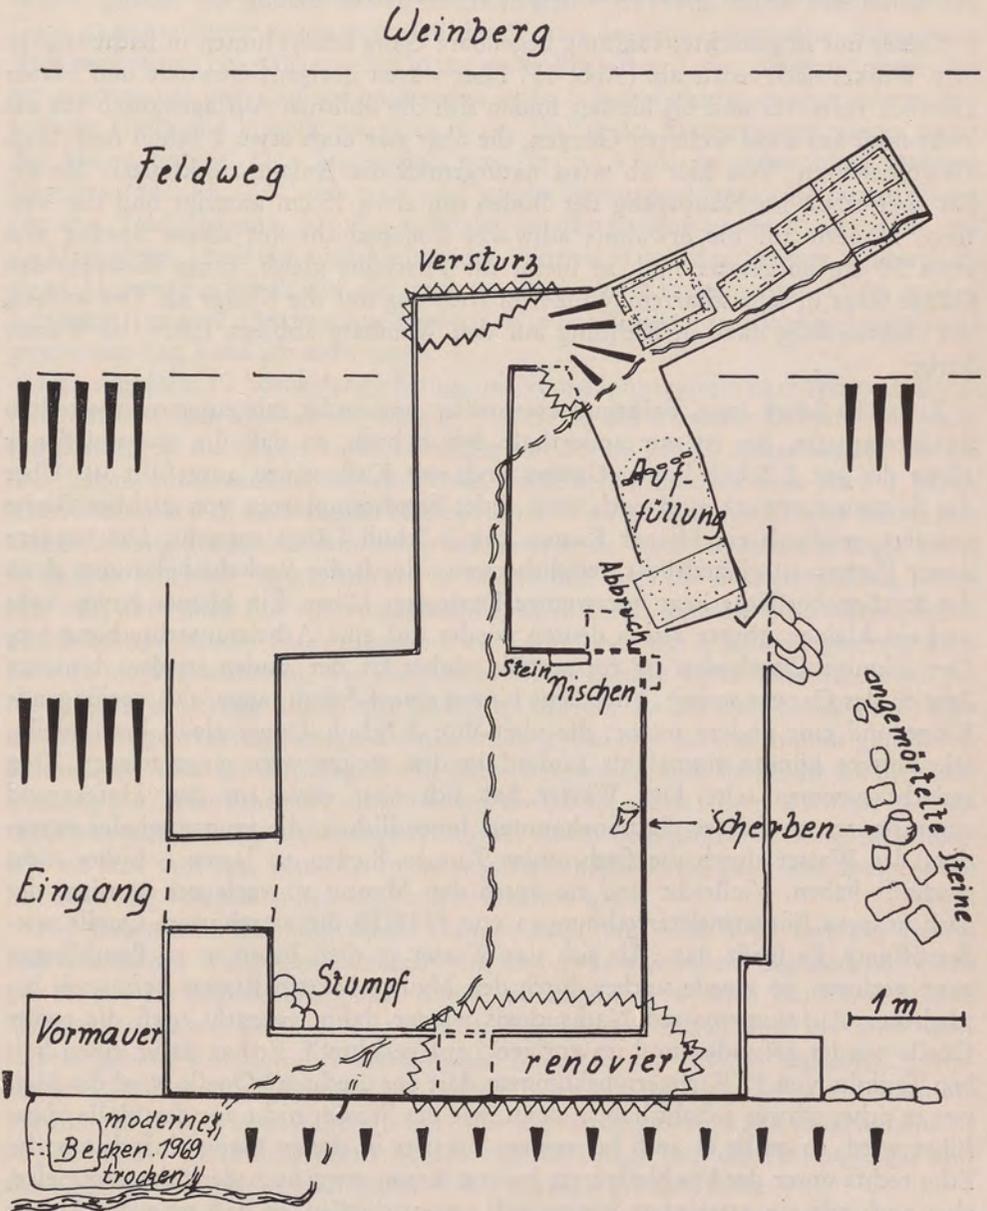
Grundriß der Brunnenstube in der Baierklinge
